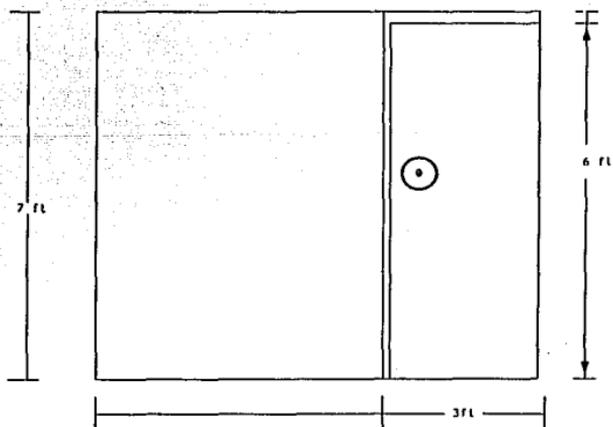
DIMENSIONES DE LA FACHADAS
